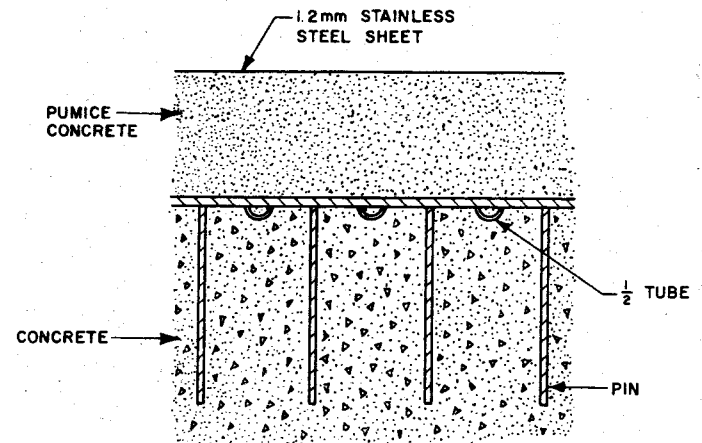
b - Conjunto Concreto - Liner - Barreira
